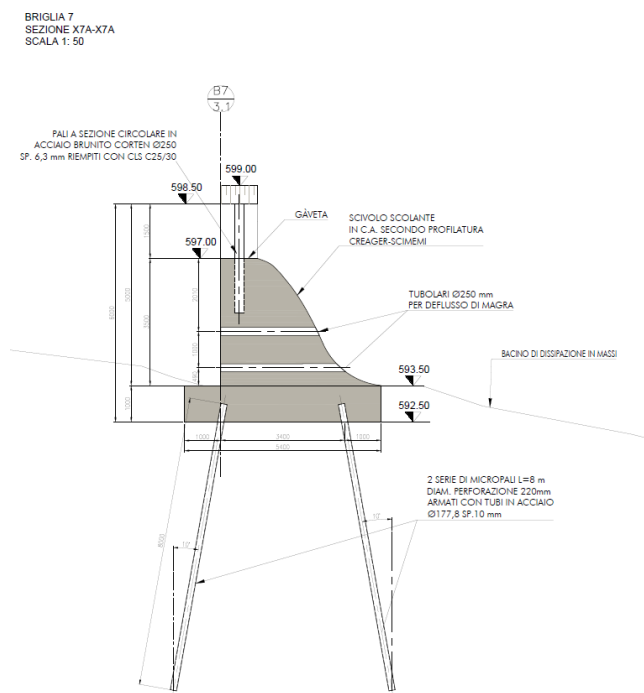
Sezione trasversale briglia n.7 con scivolo in profilo Creager-Scimemi
